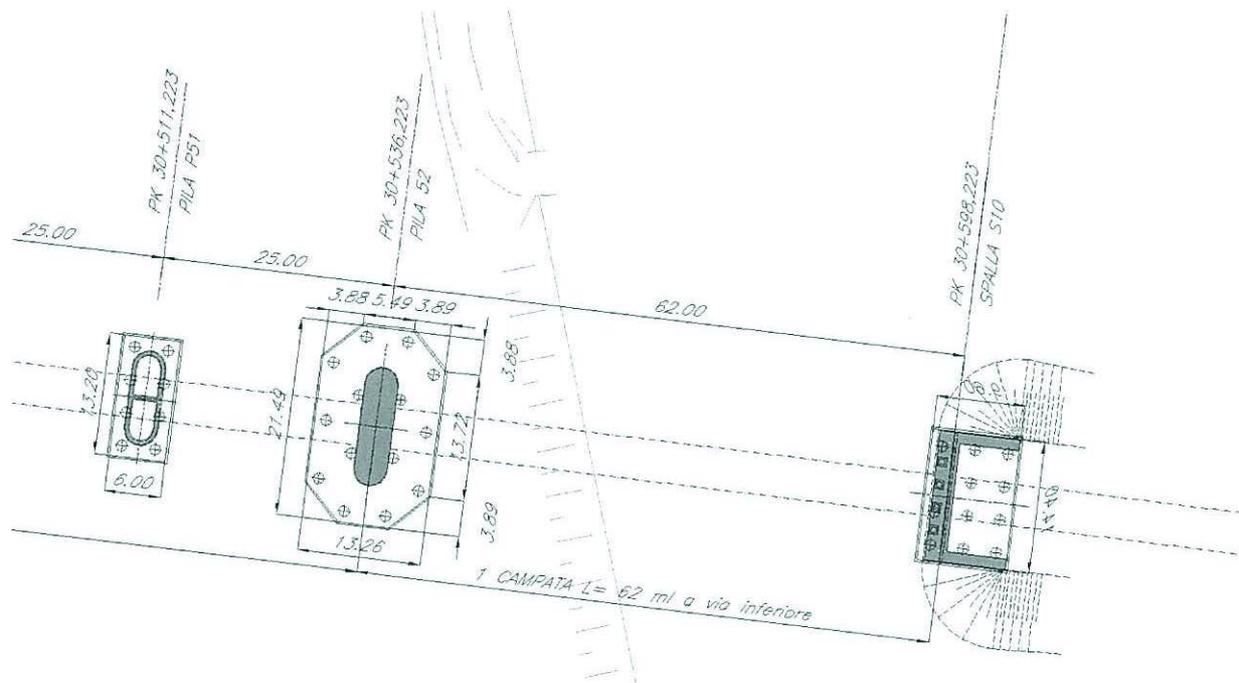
Pianta fondazioni dell'attraversamento della Roggia Giarina.
